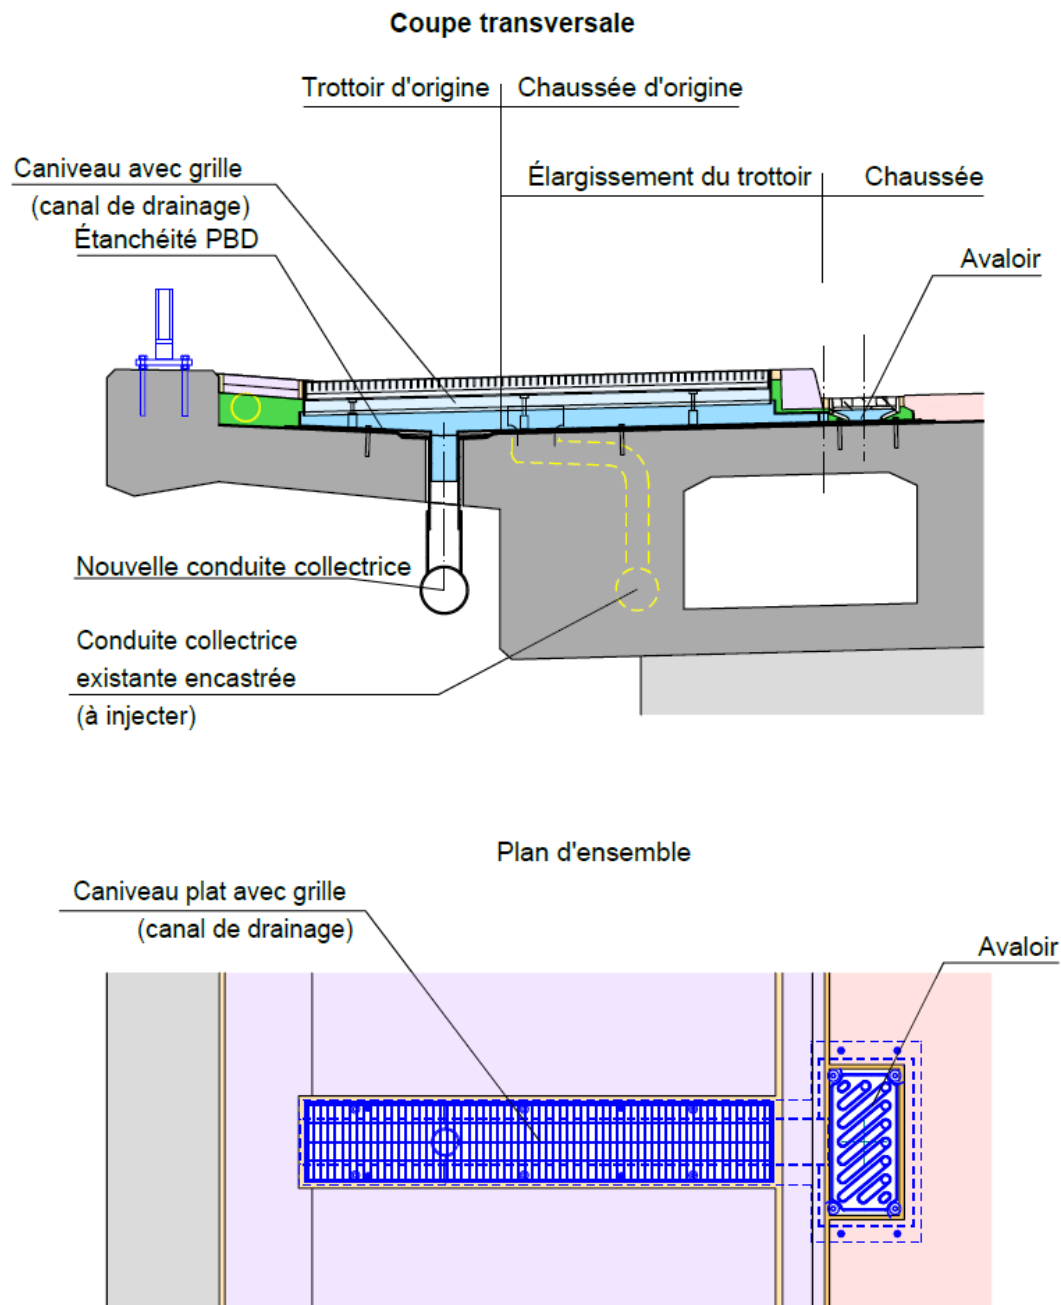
Exemple; fabrication spéciale d'un caniveau en remplacement d'un collecteur existant noyé dans l'âme d'un caisson à la suite d'un élargissement du trottoir.
